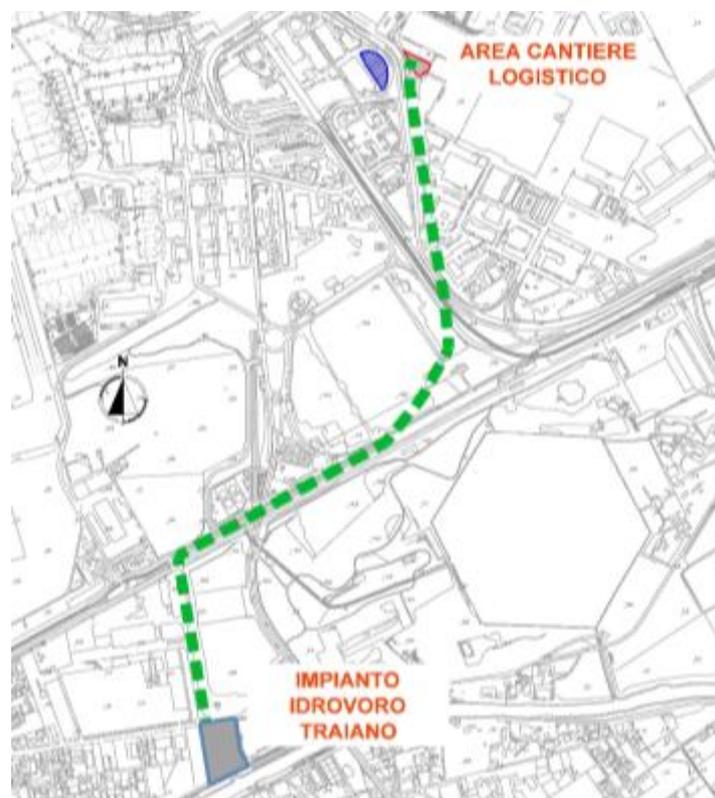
Schema planimetrico del tracciato del collettore C, canale delle Vignole e allacciante, dall'area di cantiere logistico all'impianto idrovoiro di Traiano
